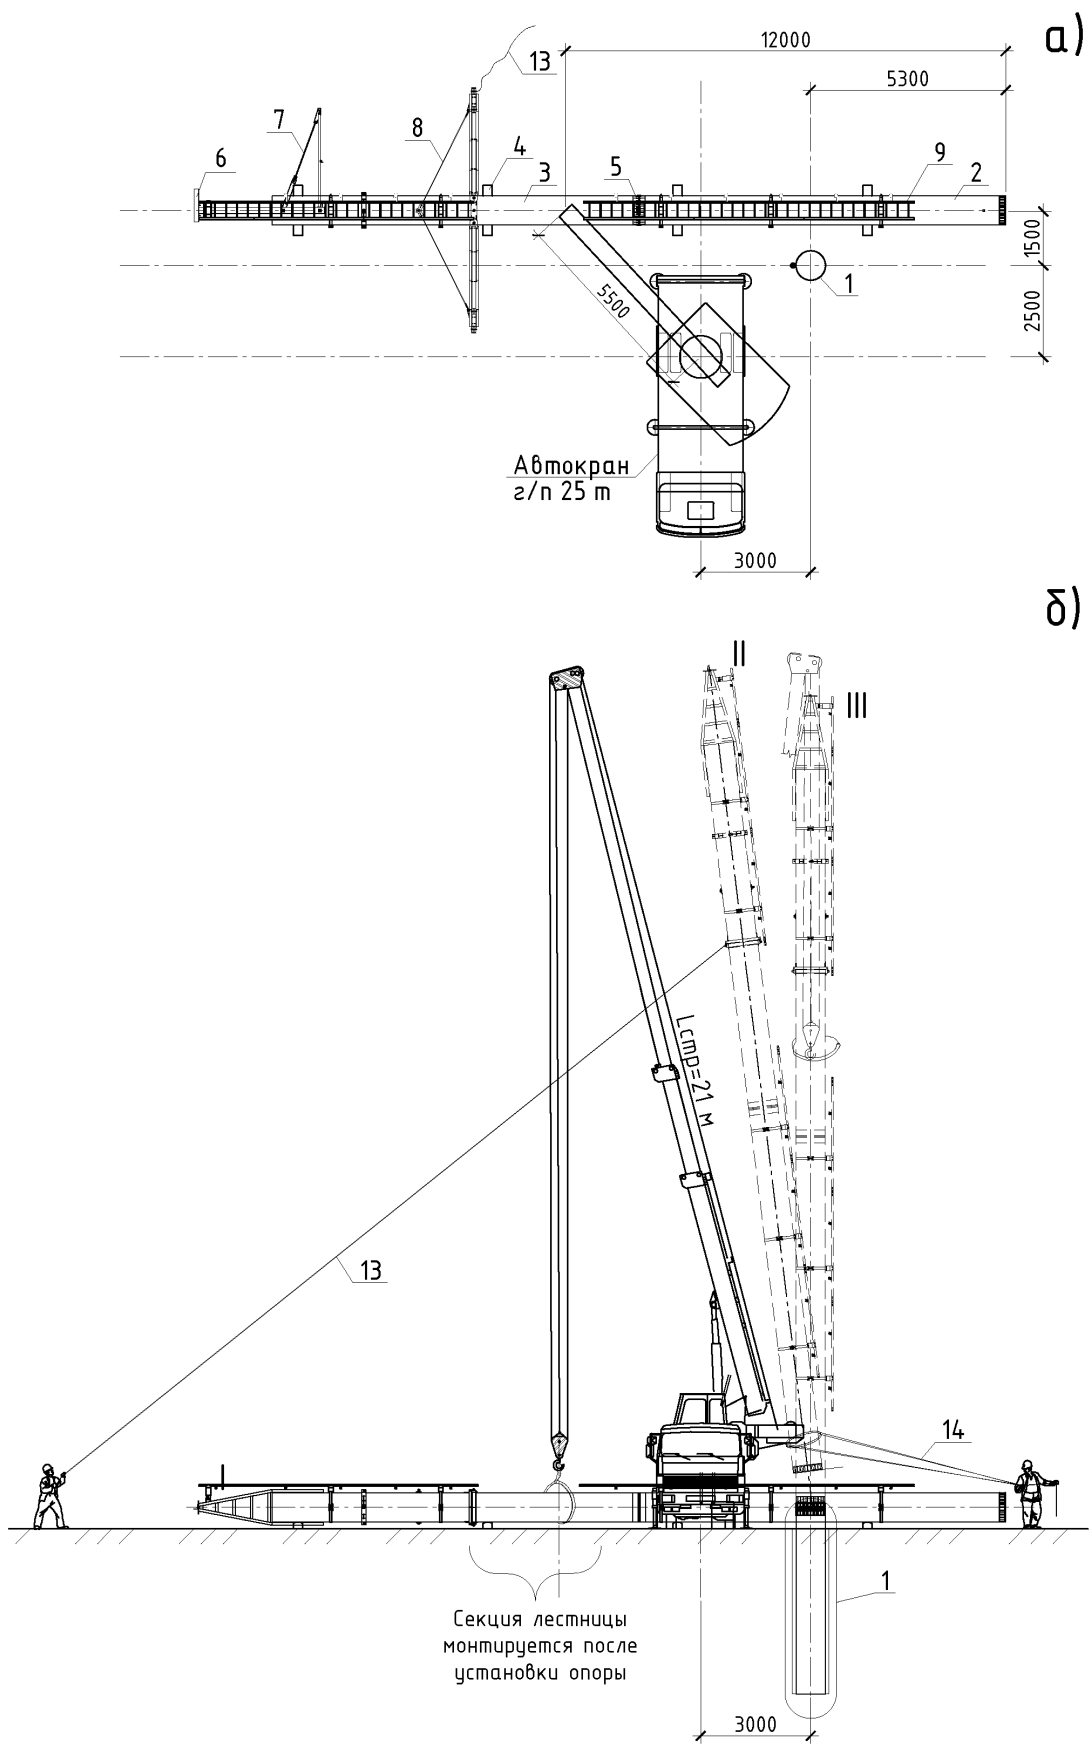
Схема сборки и монтажа опоры СУБ110-5Ф
